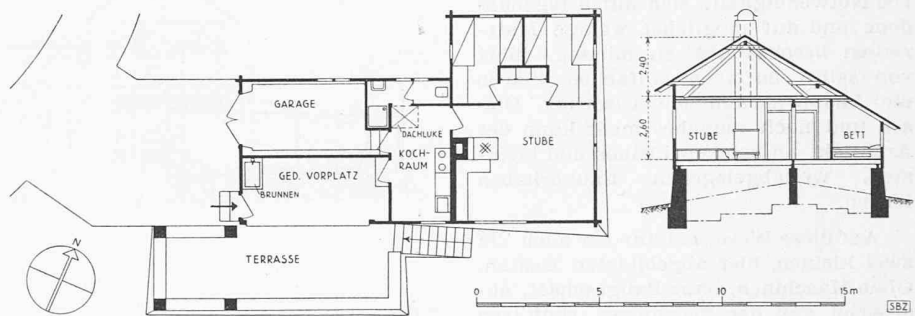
und 2. Ferienhaus in Voralp bei Grabs. Blockhaus mit Schindeldach; Südostansicht, Grundriss und Schnitt 1:300. Architekt CONRAD D. FURRER, Zürich
